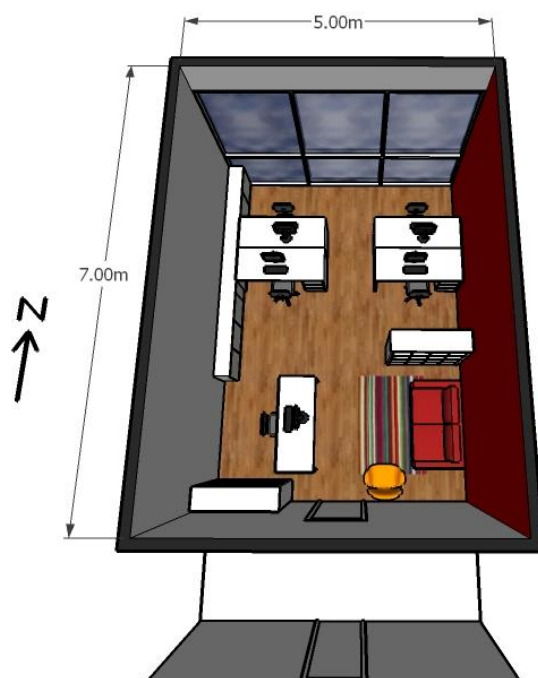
Planta da sala comercial : Modelo A - FS
